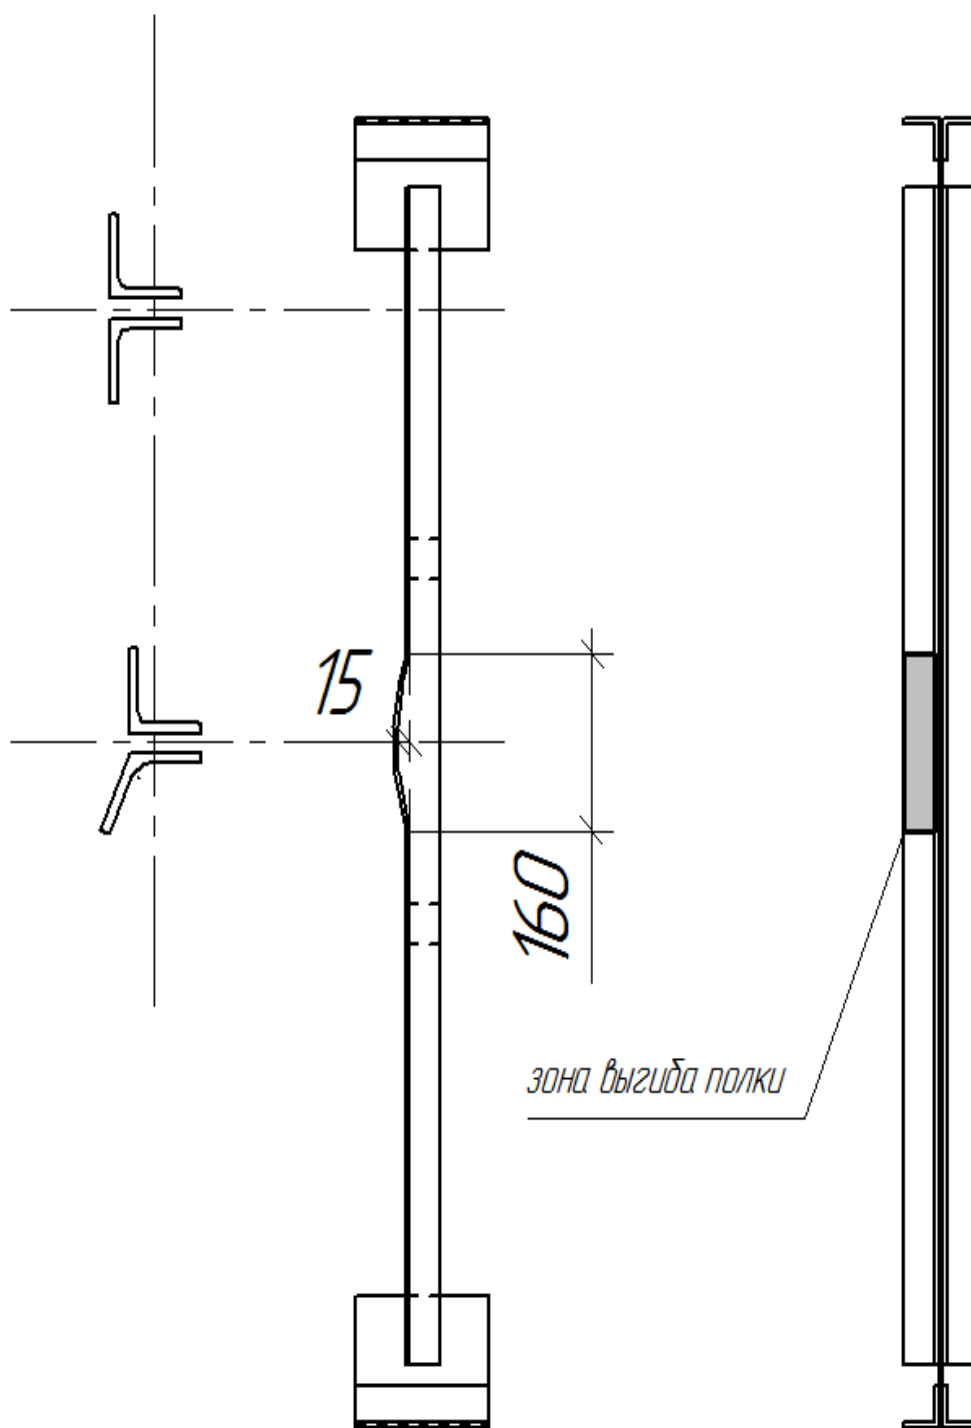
Деформированный сжатый стержень с выгибом одной из полок уголка
